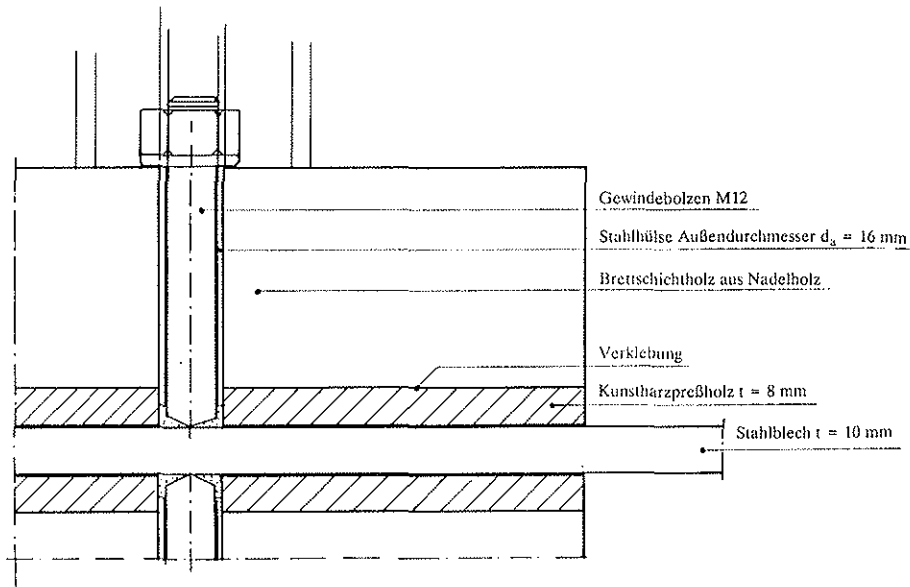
Verstärkte Stahlblech-Holz-Verbindung mit aufgeschweißten Gewindebolzen
